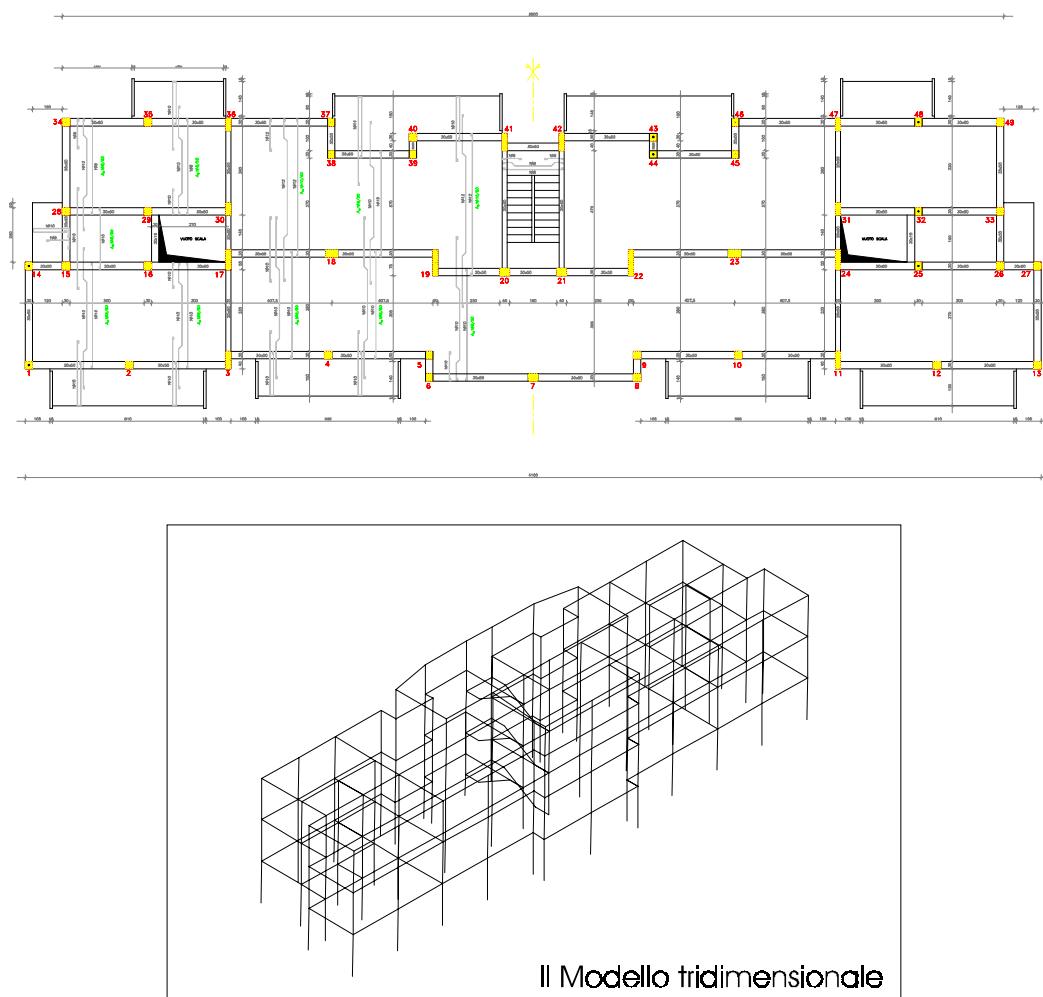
Pianta piano primo e vista assonometrica edificio Monterosso.
